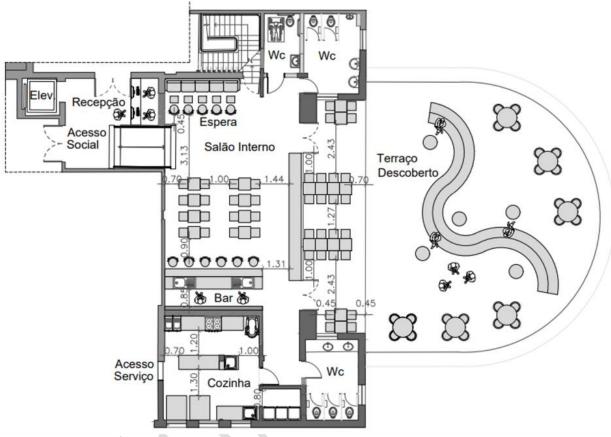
Planta Baixa: ESPAÇO GASTRONÔMICO
